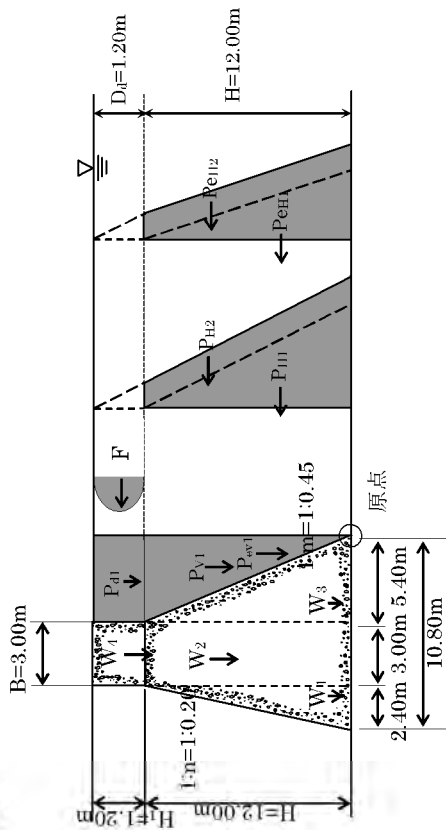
砂防堰堤に作用する力 (断面 (1) : 土石流時)
